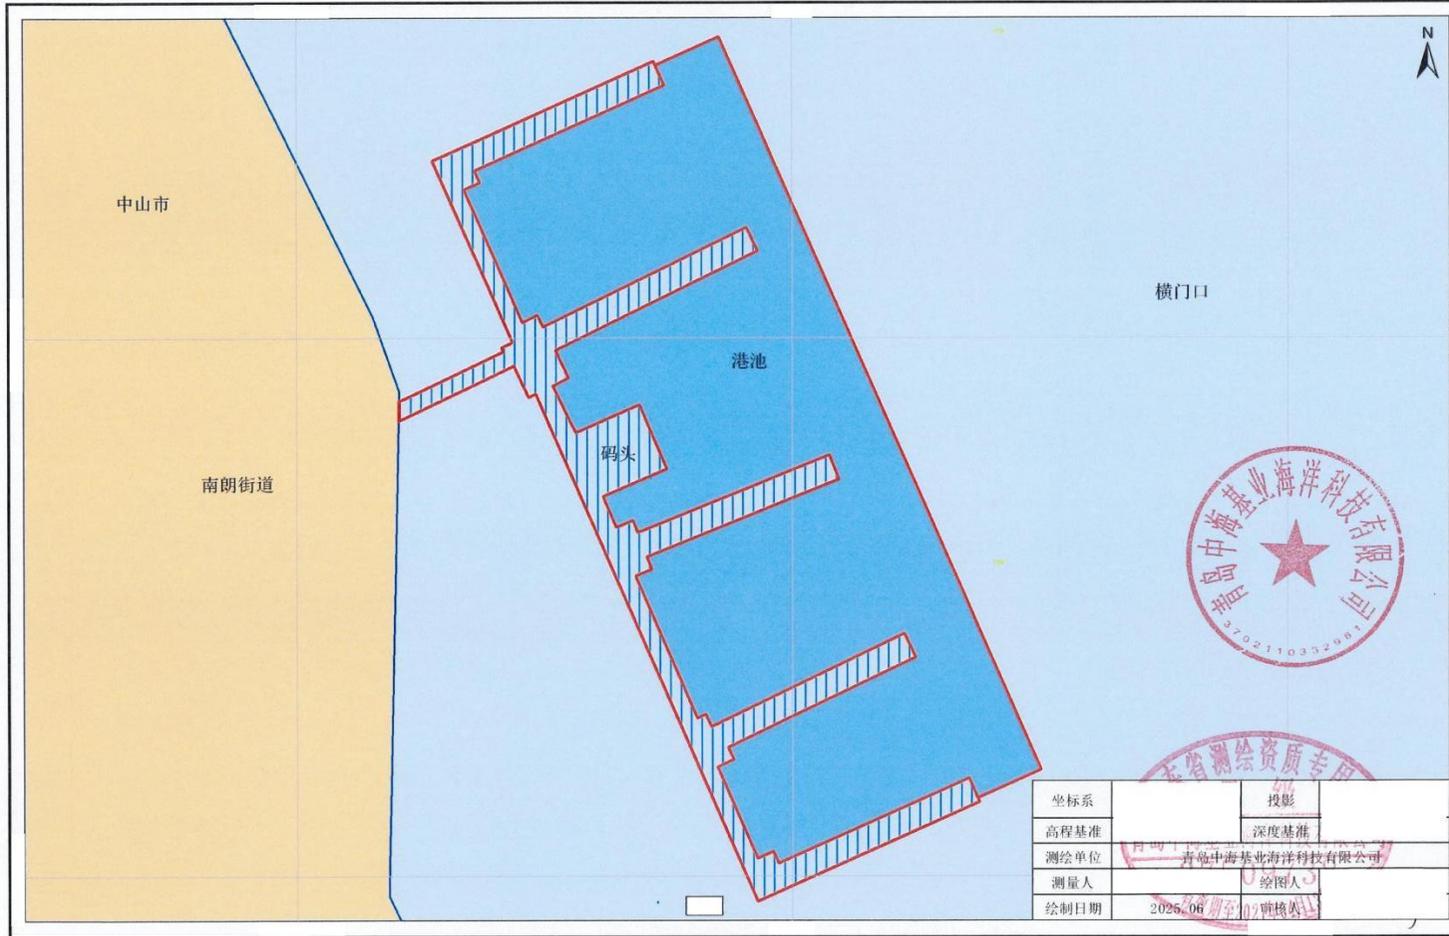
拟申请用海项目宗海平面布置图
